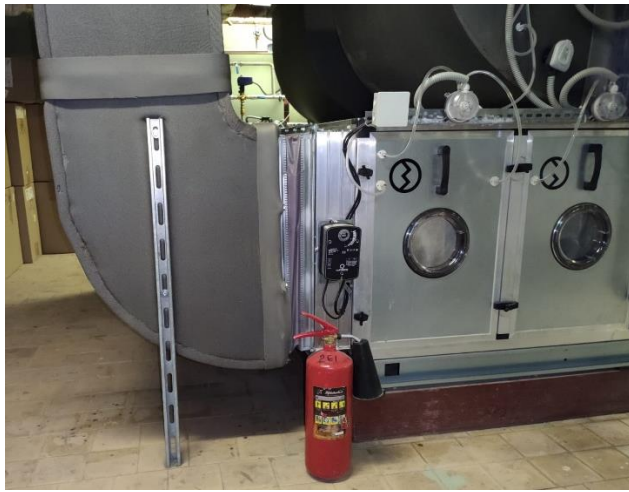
Имеется перекося гибкой вставки на вентиляционной установке П15, что в последующем приведет к ее разрыву
